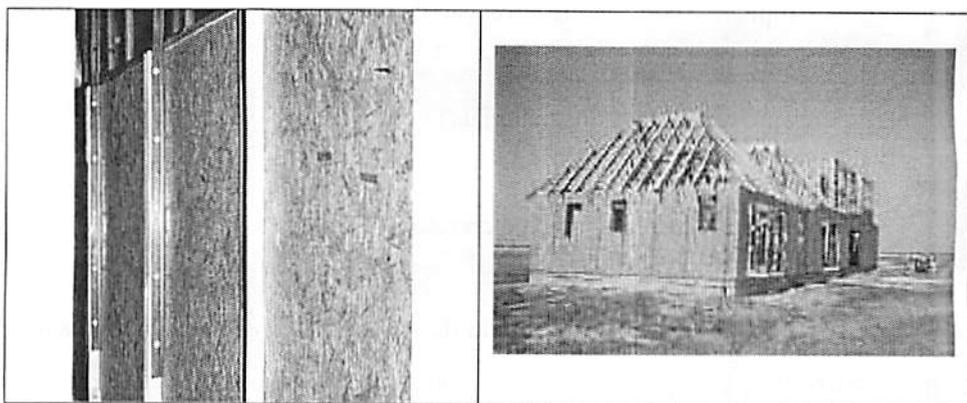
Painéis de madeira fixados em estrutura metálica
